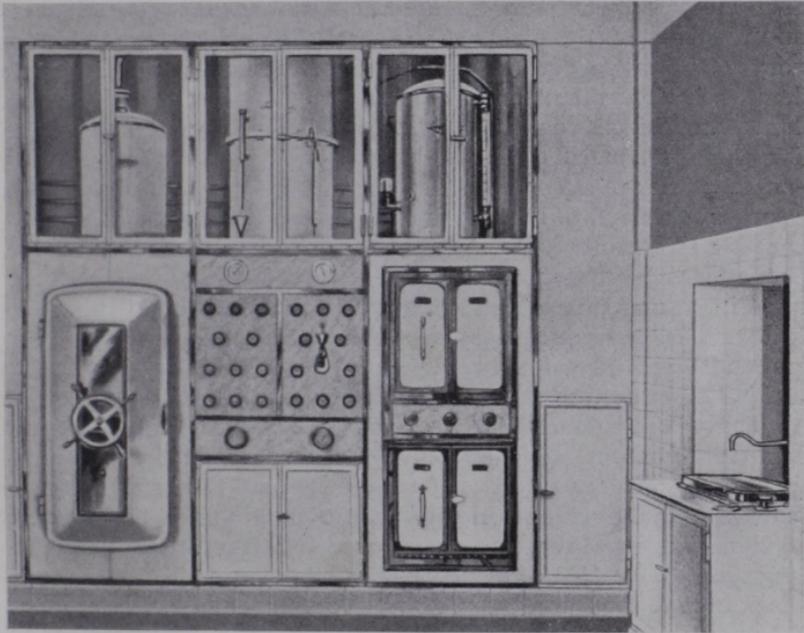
Augsburg, Städt. Krankenhaus. Sterilisieranlage nach J. u. M. Lautenschläger, G. m. b. H. Berlin.
